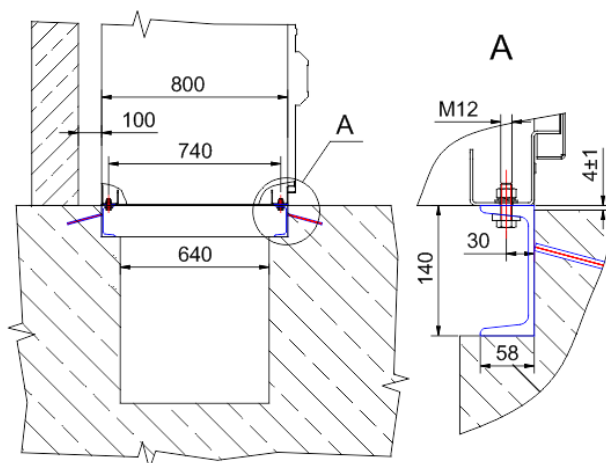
Пример конструкции фундаментной рамы и кабельного канала, выполненного из швеллеров.
